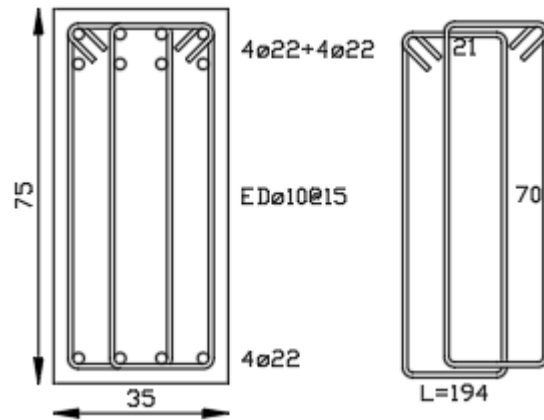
Vigas ejes B y E, nivel 1-4. Edificios de 15/20 pisos.
